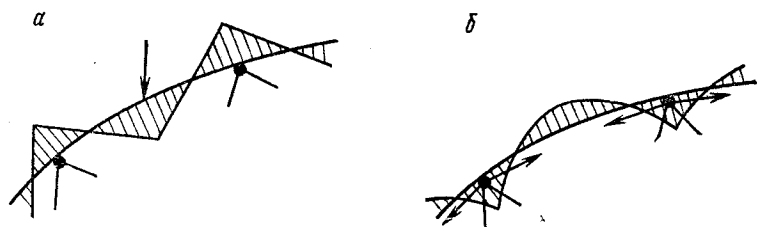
Эпюры моментов в верхнем поясе арочной фермы
